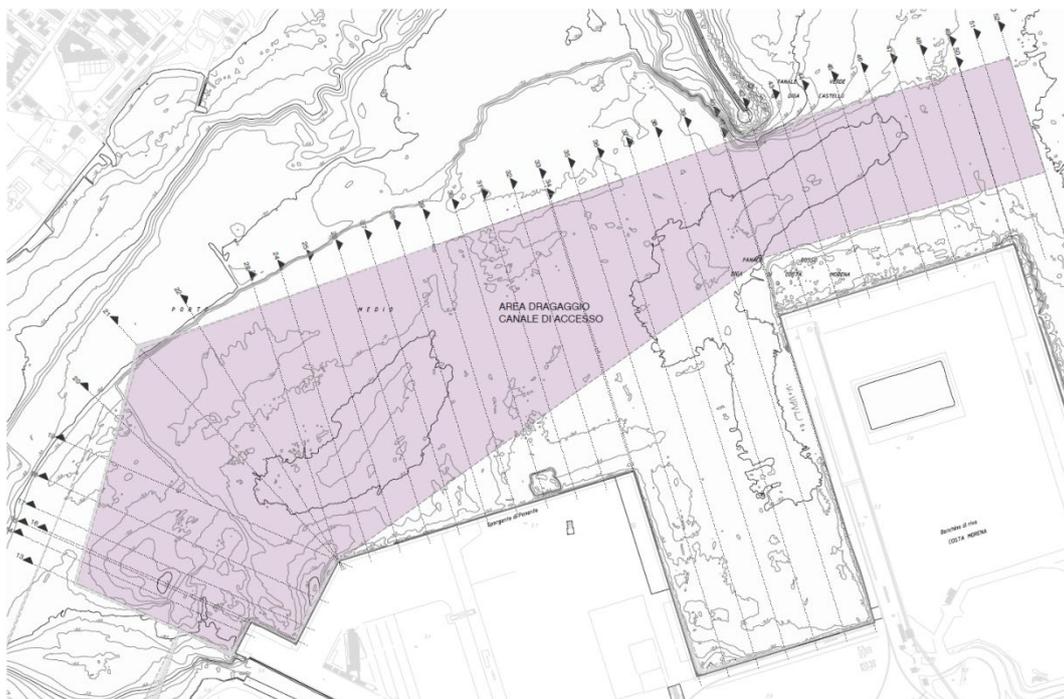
Planimetria di dragaggio Canale di accesso al porto
